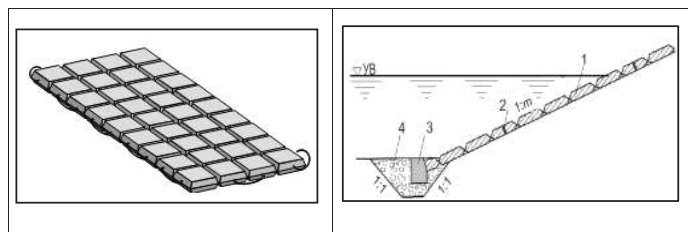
Схема укрепления берегового откоса гибкими бетонными матами:
